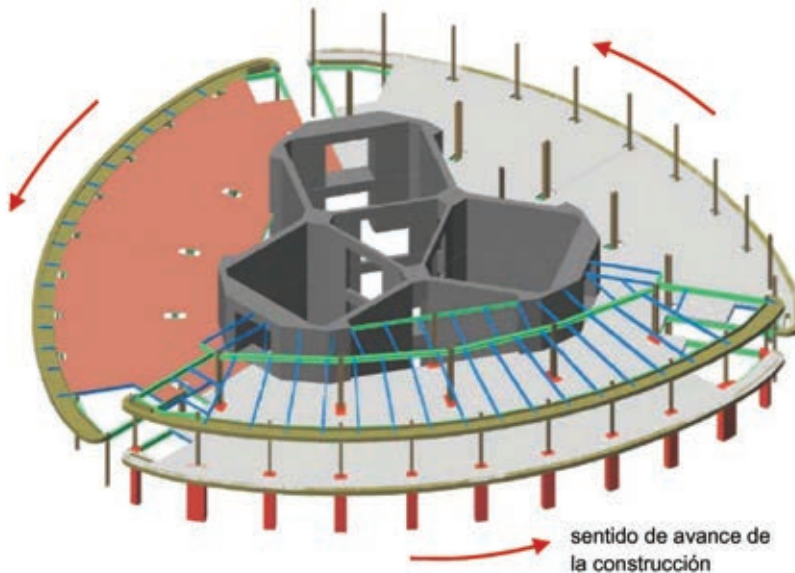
Montaje secuencial de los diferentes componentes de la estructura de los forjados que permite independizar la construcción de la estructura metálica y el vertido del hormigón
